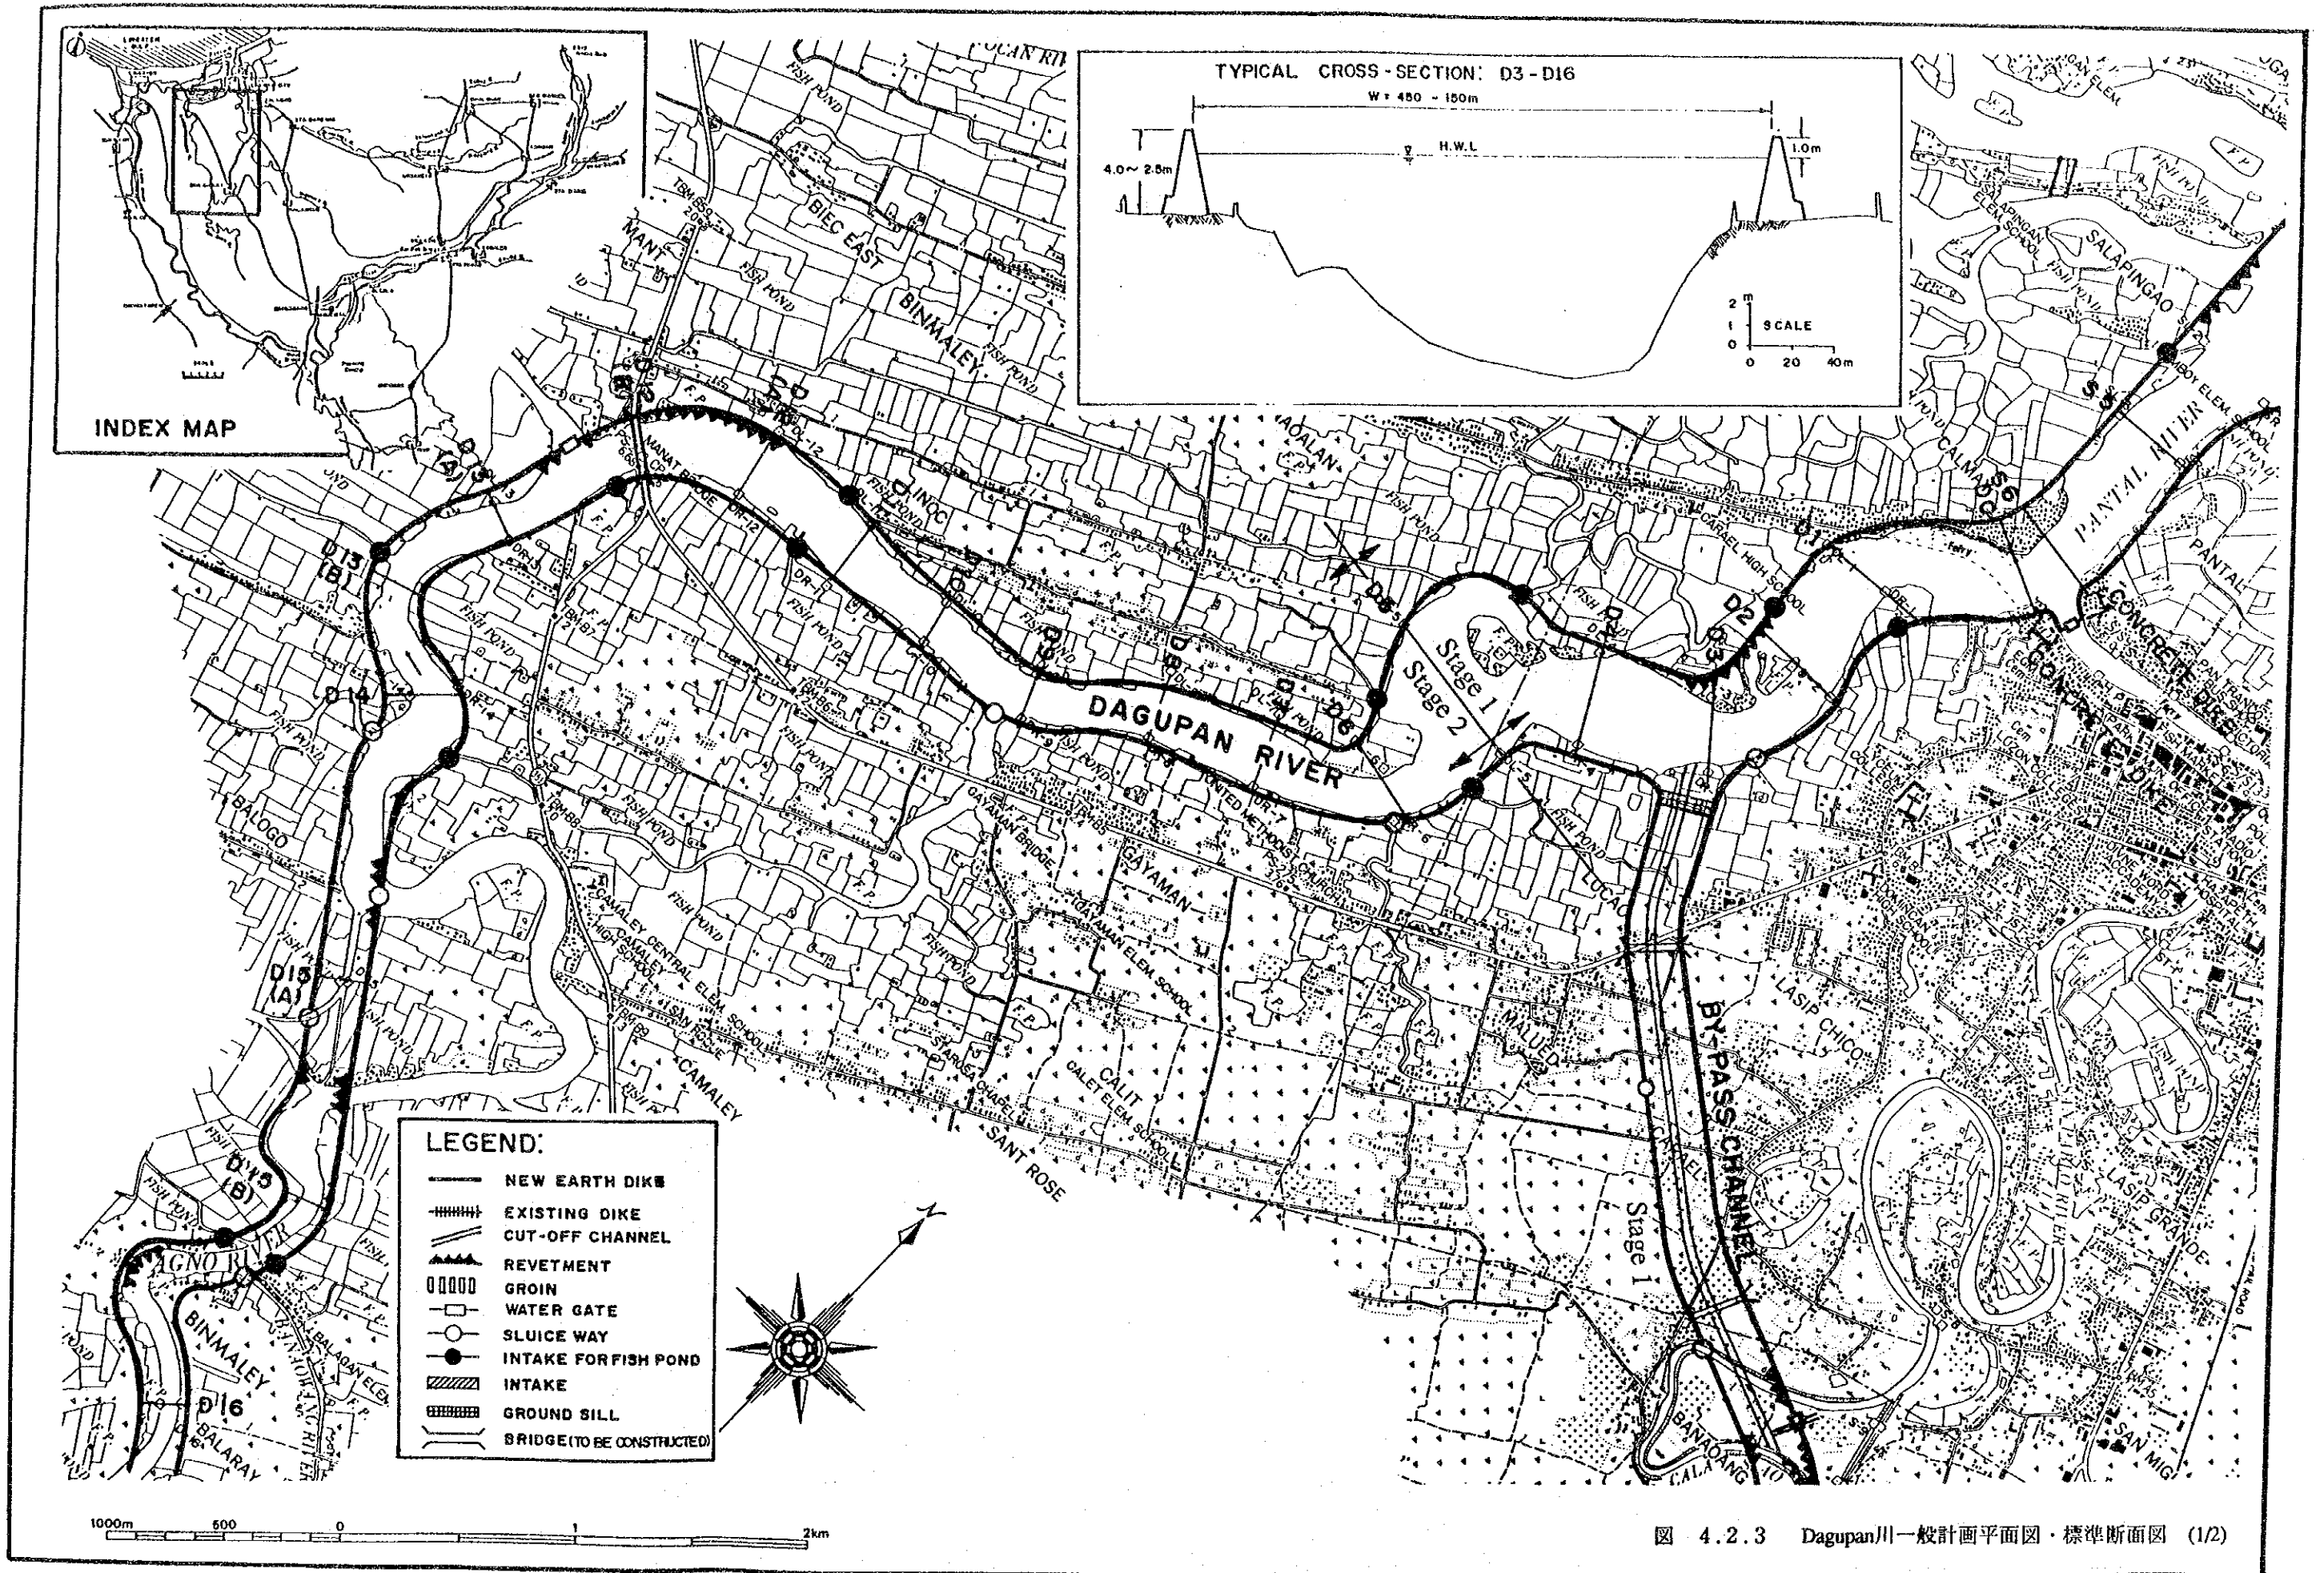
Dagupan川一般計画平面図・標準断面図 (1/2)
